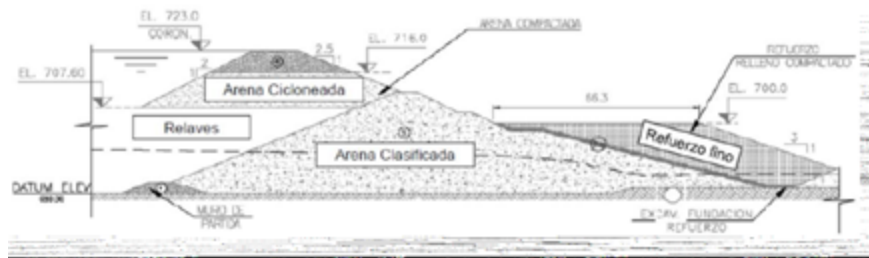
Sección transversal muro 4A del tranque Cauquenes
